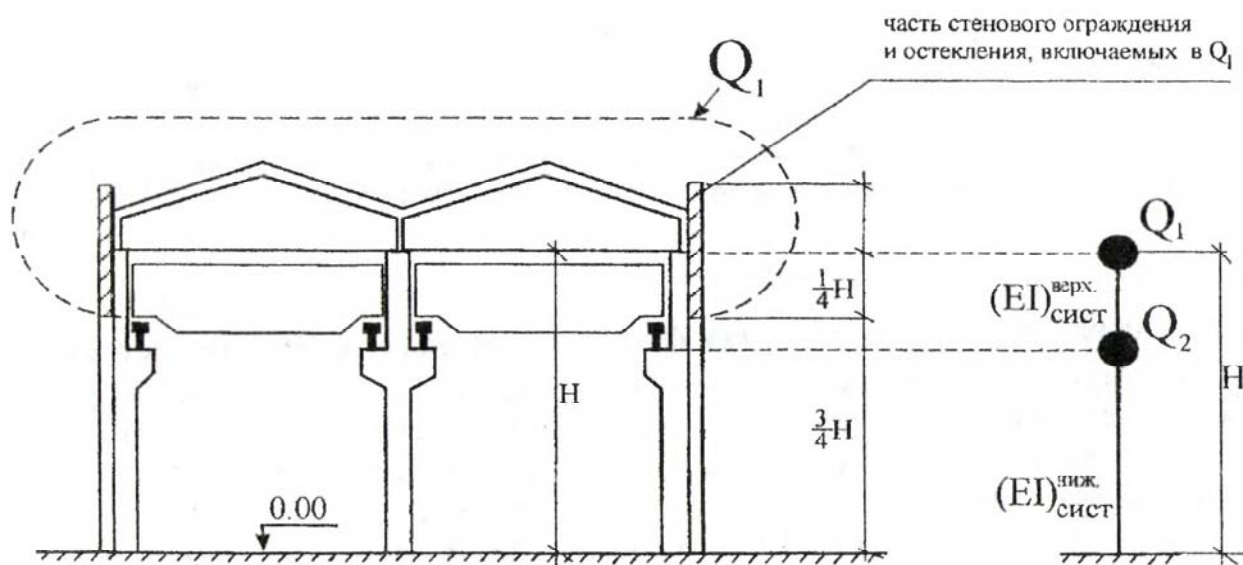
Формирование динамической расчетной схемы для производственного здания с мостовыми кранами (вариант с шарнирным соединением балок с колоннами)
